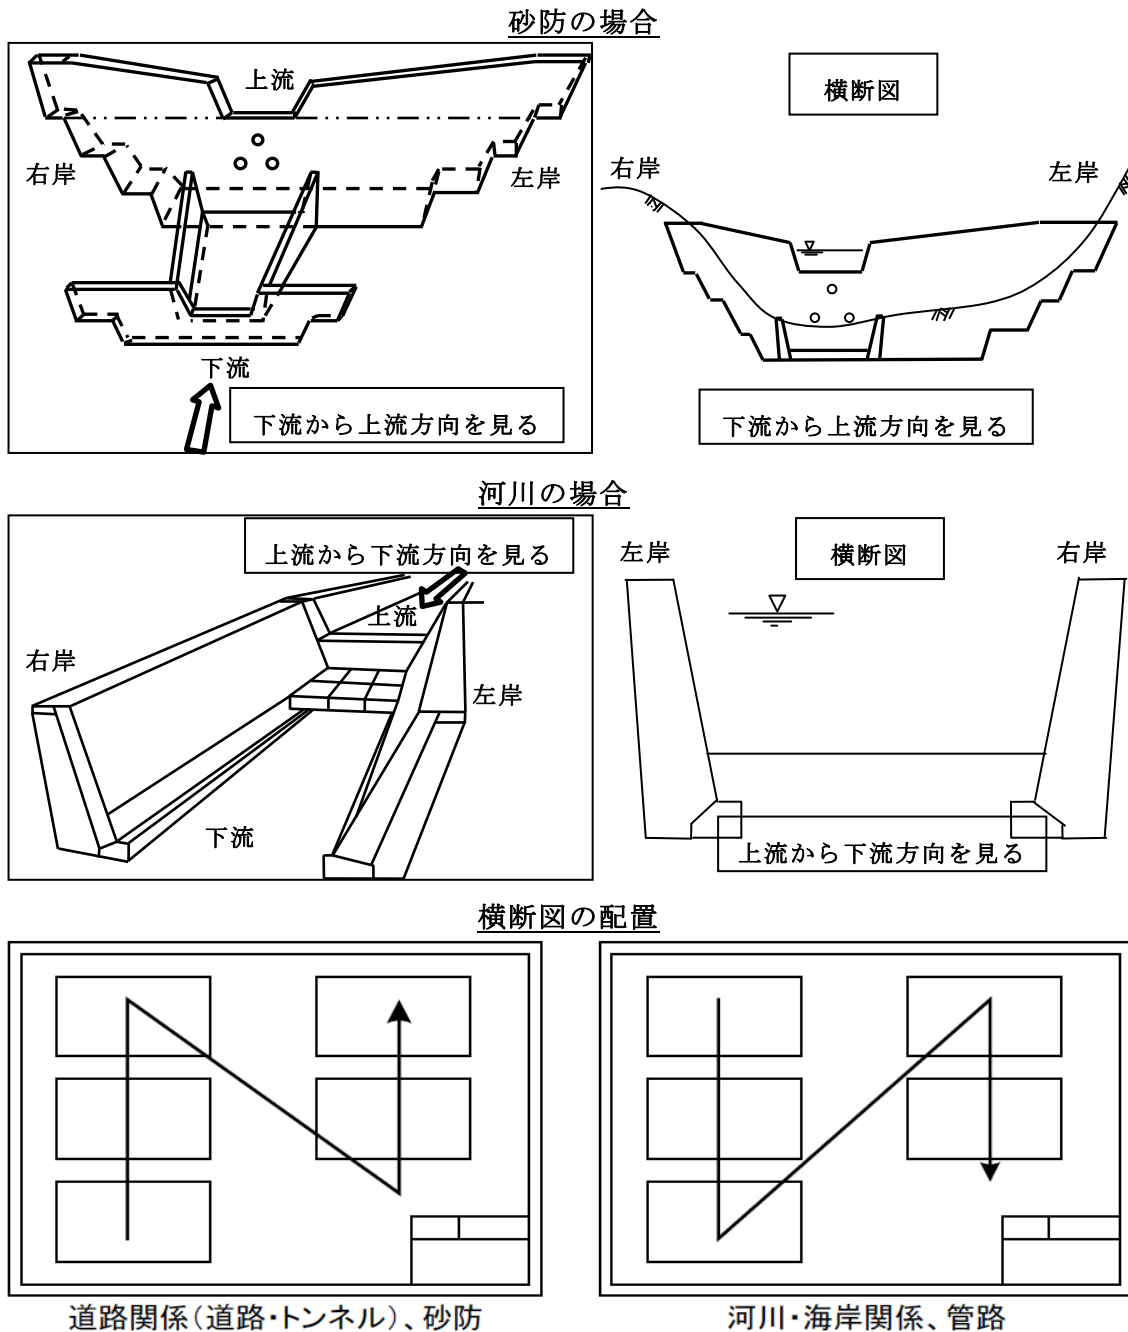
見通し方向及び図面レイアウト(横断測量)
